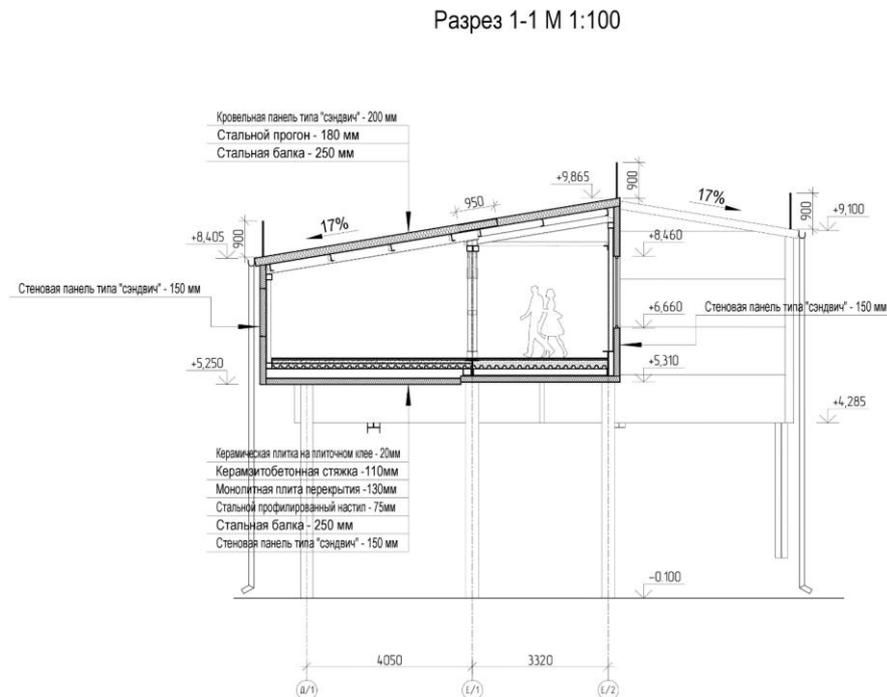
Поперечный разрез по реконструируемому переходу
